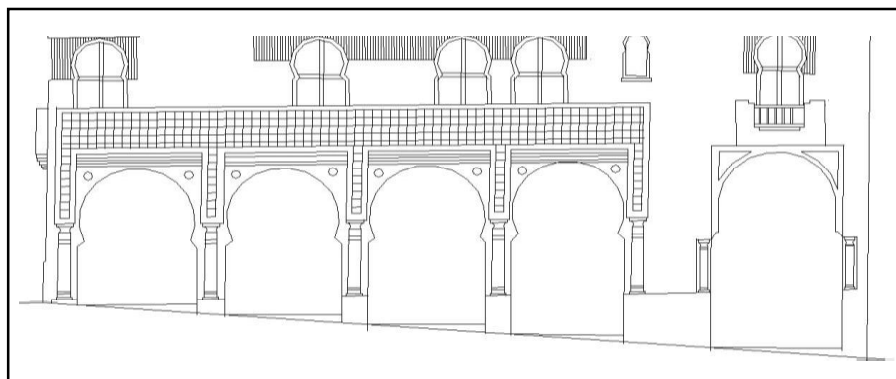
Façade sur la rue Mohamed Affroune, accès au sous-sol.
